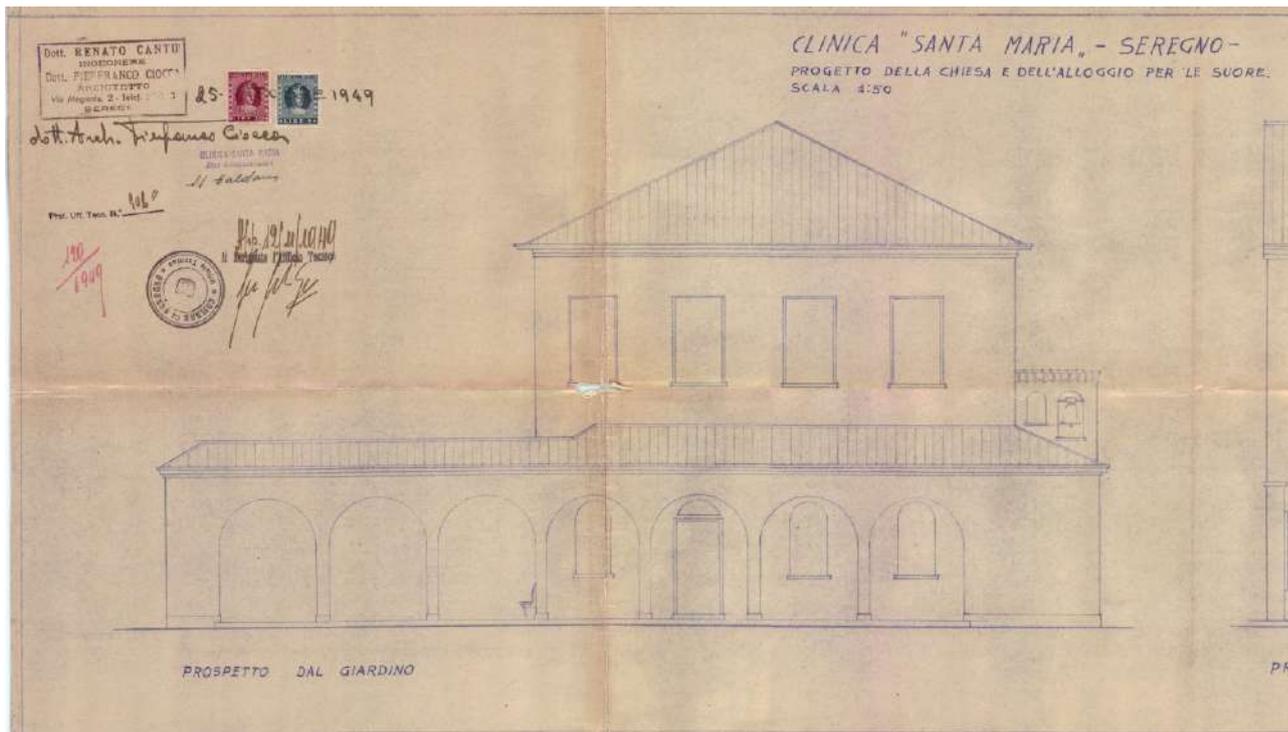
Prospetto Est, pratica edilizia 129/1949, Archivio Comune di Seregno.
